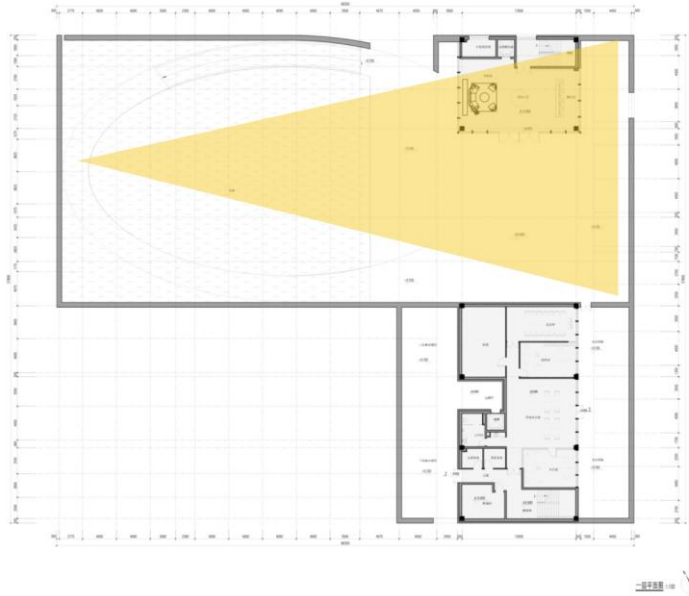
22 Programing dan Sirkulasi Denah Lantai Satu
